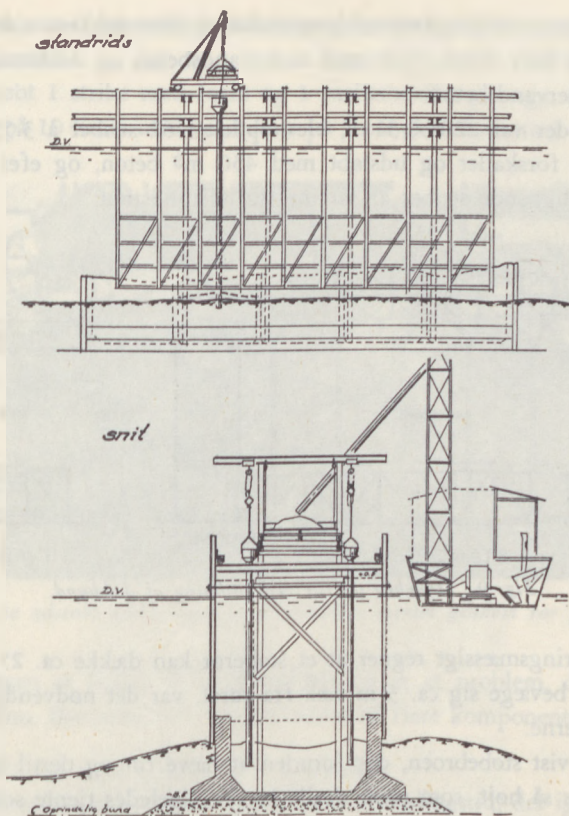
Arrangement af undervandsstøbning i Gdynia.
